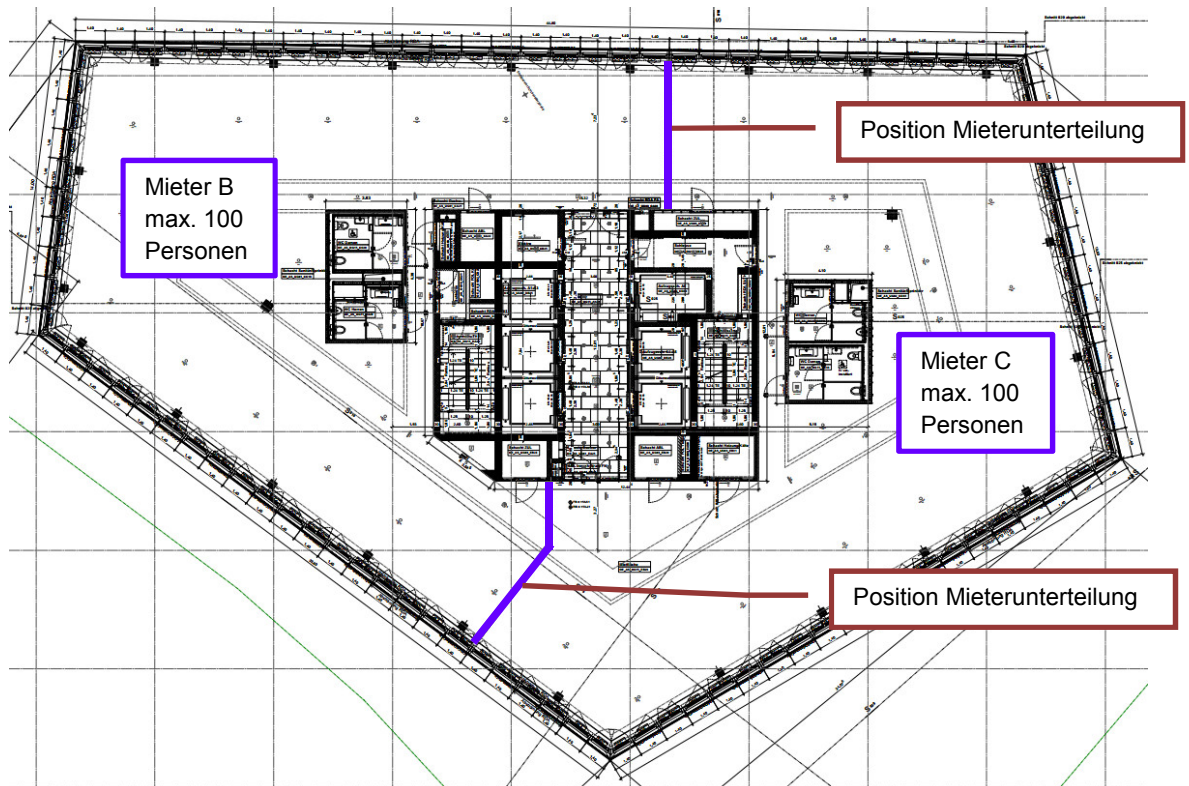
Grundriss Regelgeschoss von Hochhaus mit Unterteilung (2 Mieter)
